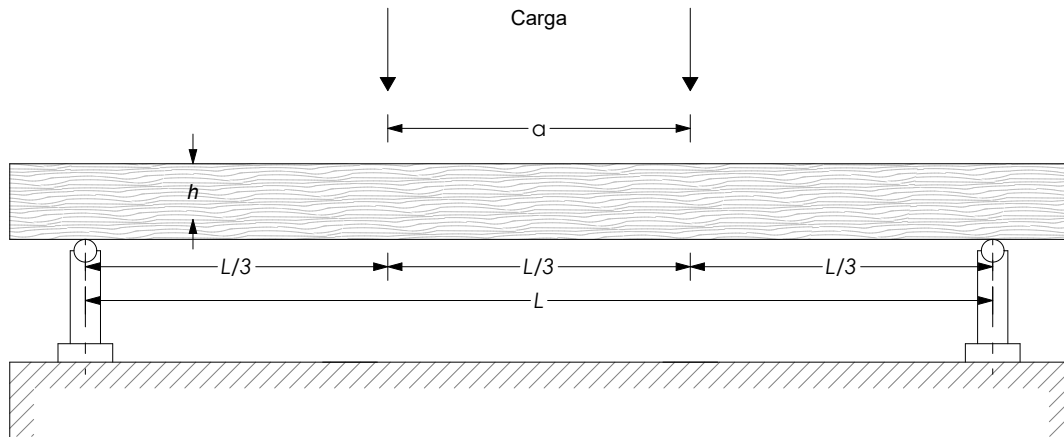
Viga simplemente apoyada con cargas a los tercios de la viga
